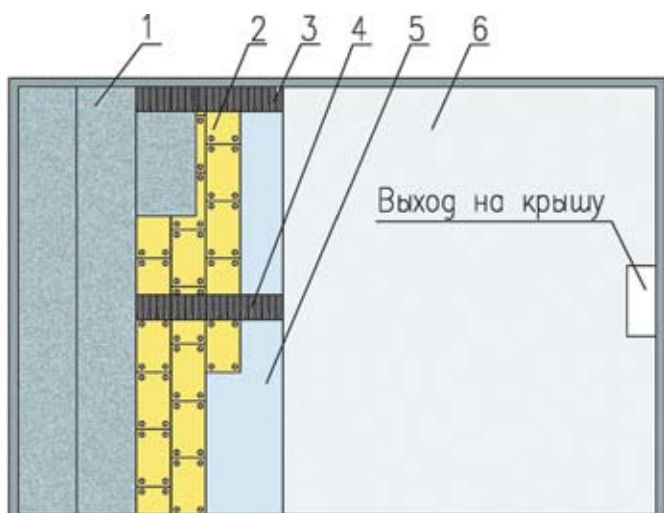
Схема монтажа утеплителя: 1 – кровельная мембрана; 2 – теплоизоляционный слой; 3 – инвентарные мостки для движения рабочих; 4 – изменение направления движения рабочих; 5 – пароизоляция; 6 – бетонное покрытие
